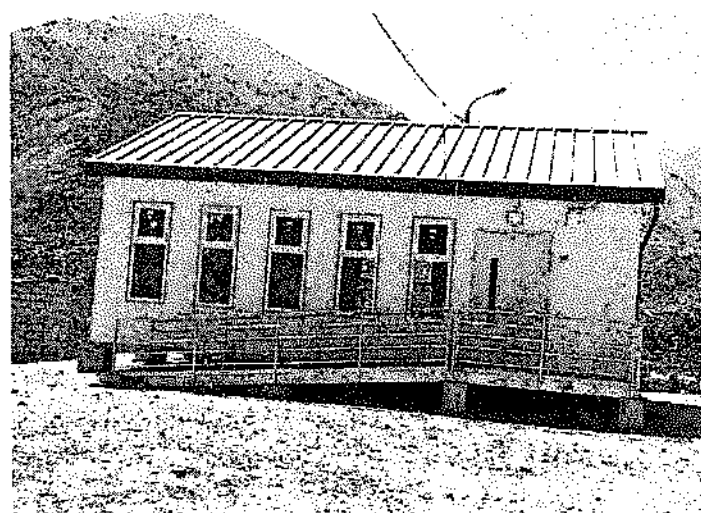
Vista del aula MPF del pabellón 04 (a la izquierda)
